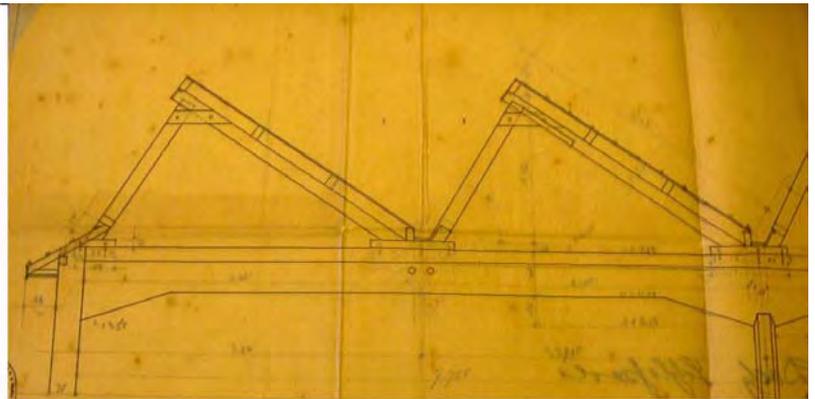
Detalhamento dos sheds do pavilhão dos cofres.
